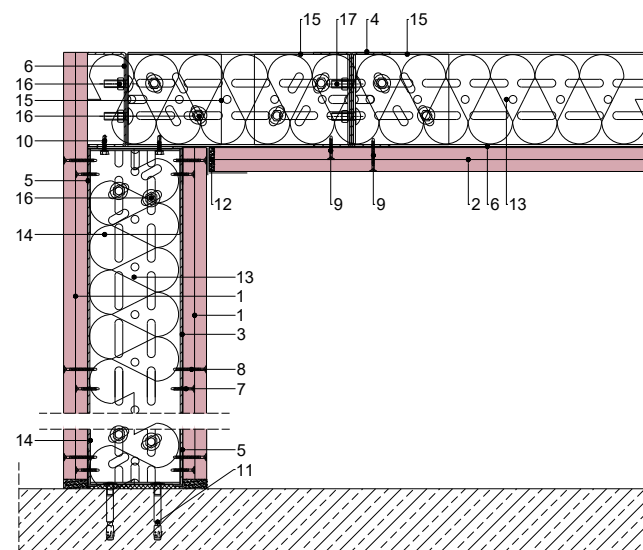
Przekrój poziomy - detal 1 (naroże ściany)
